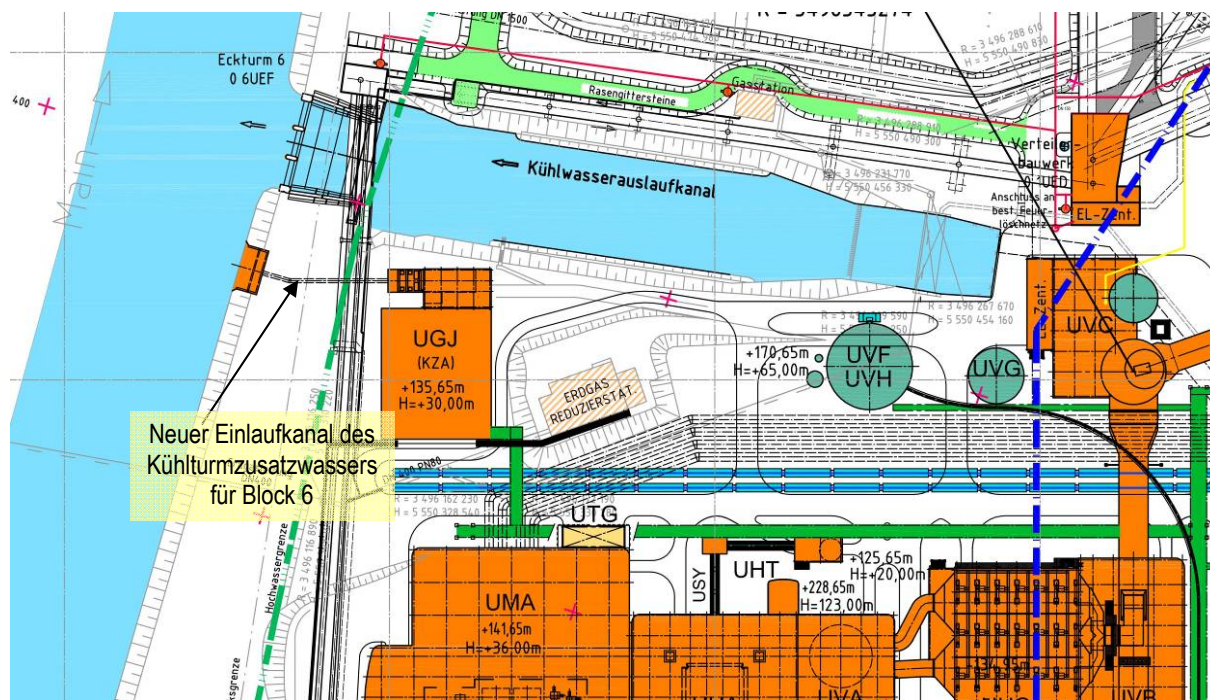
Lageplan des neuen Kühlturmsatzwassereinflaufkanals für den geplanten Block 6
